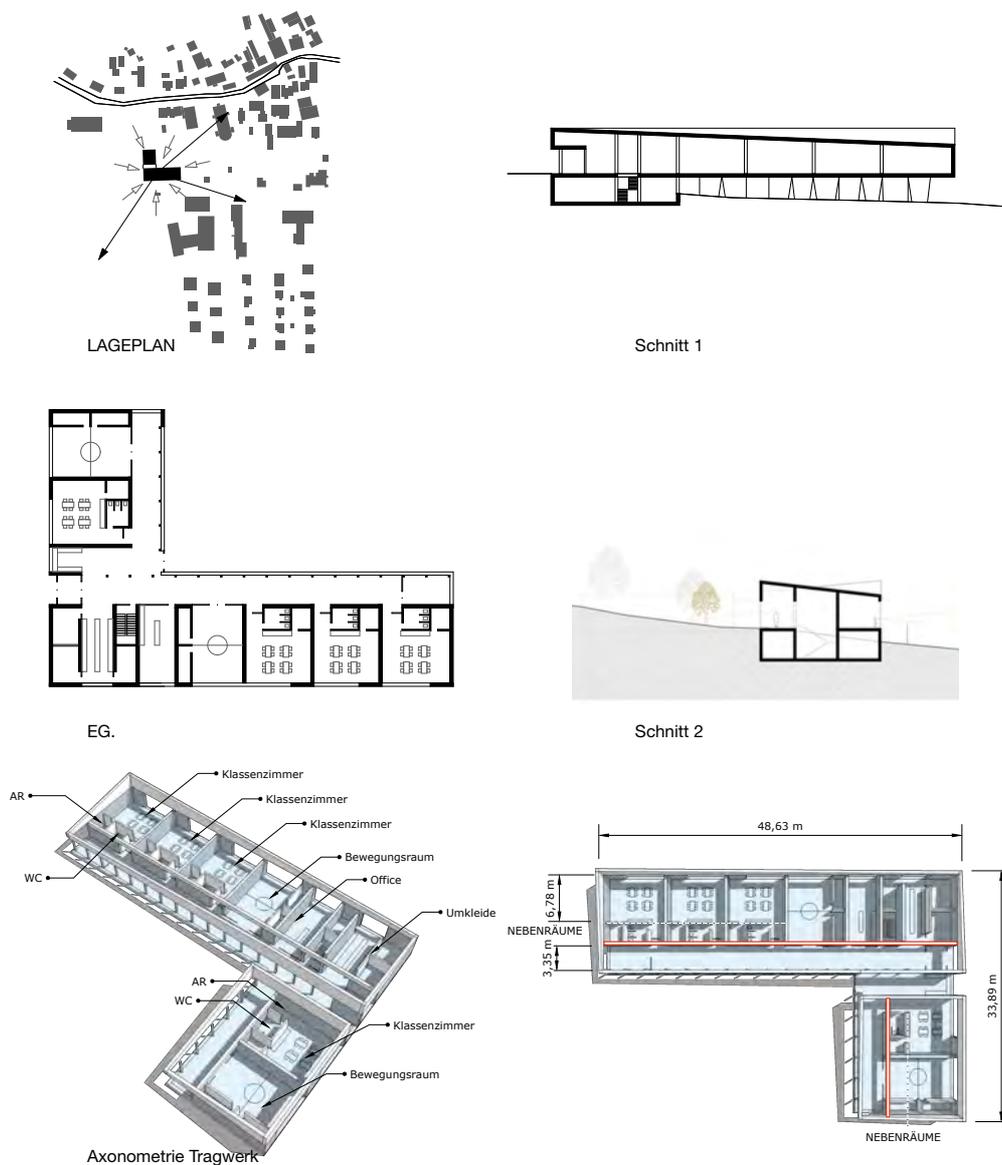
Kindergarten - Haus im Ennstahl; Arch.: Krainer Architekten; Haus im Ennstahl (AUT)
